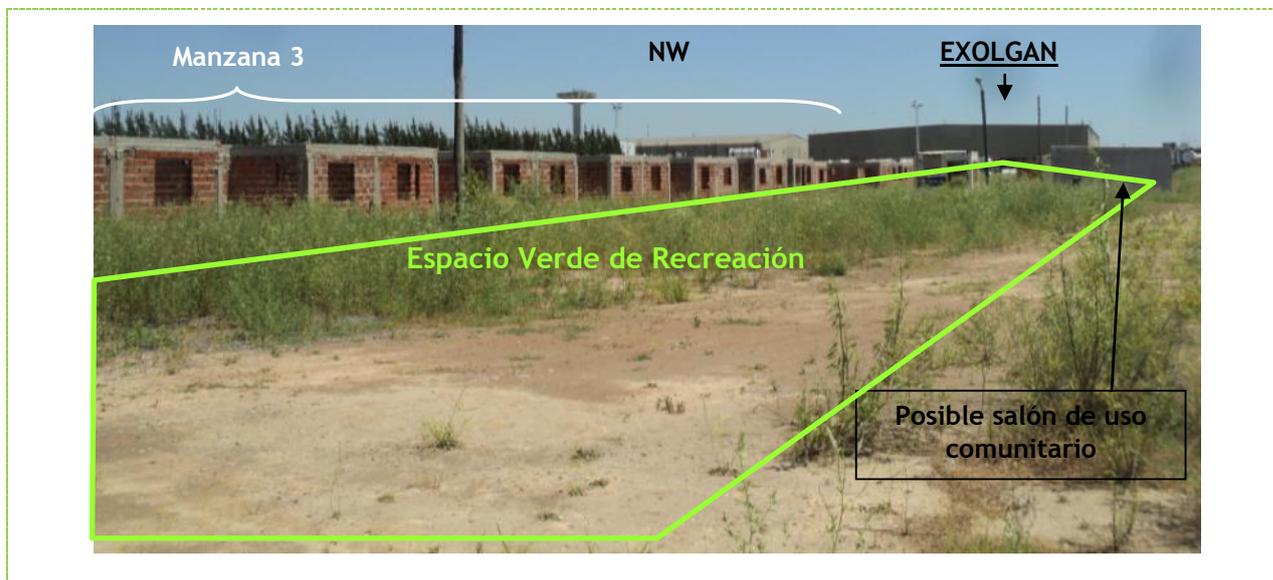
Vista general del predio desde el margen sur hacia el NW. Se observa el área central del Plan de viviendas donde se ubicará el Espacio Verde de Recreación. Se detalla Manzana 3 del Plan.
